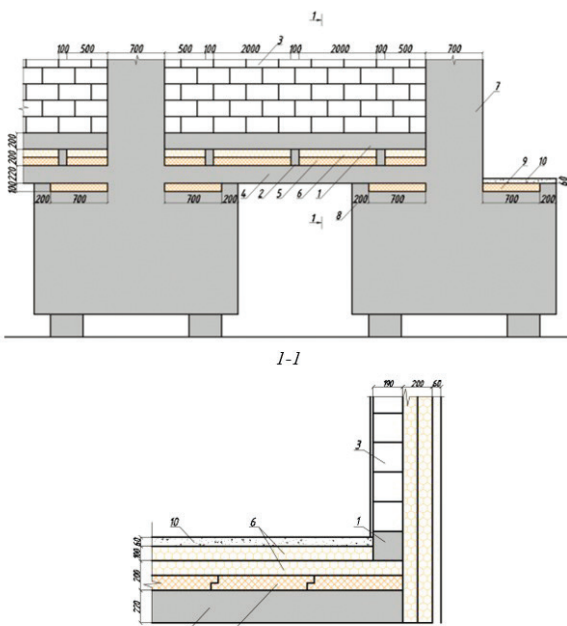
Терморазрыв между плитой цокольного перекрытия и ростверком в крайних осях здания
